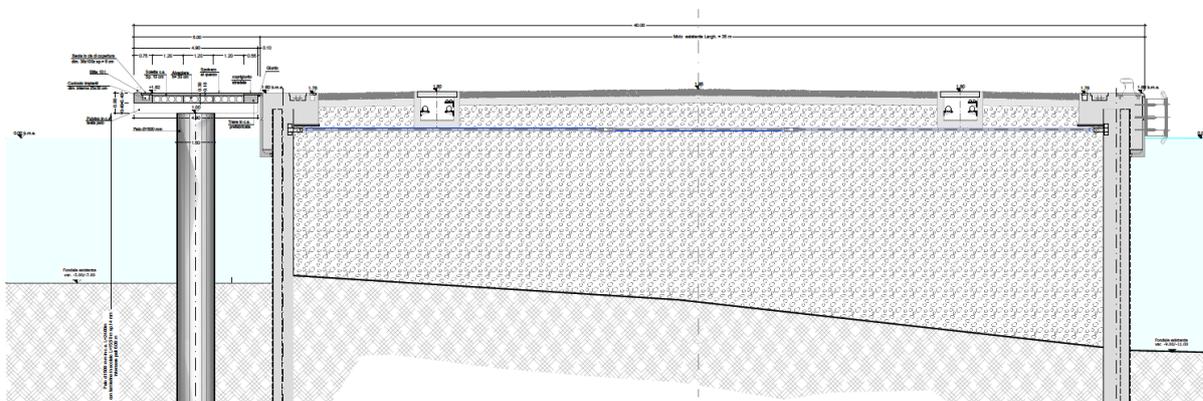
Sezione tipologia di progetto in corrispondenza del pontile in ampliamento
